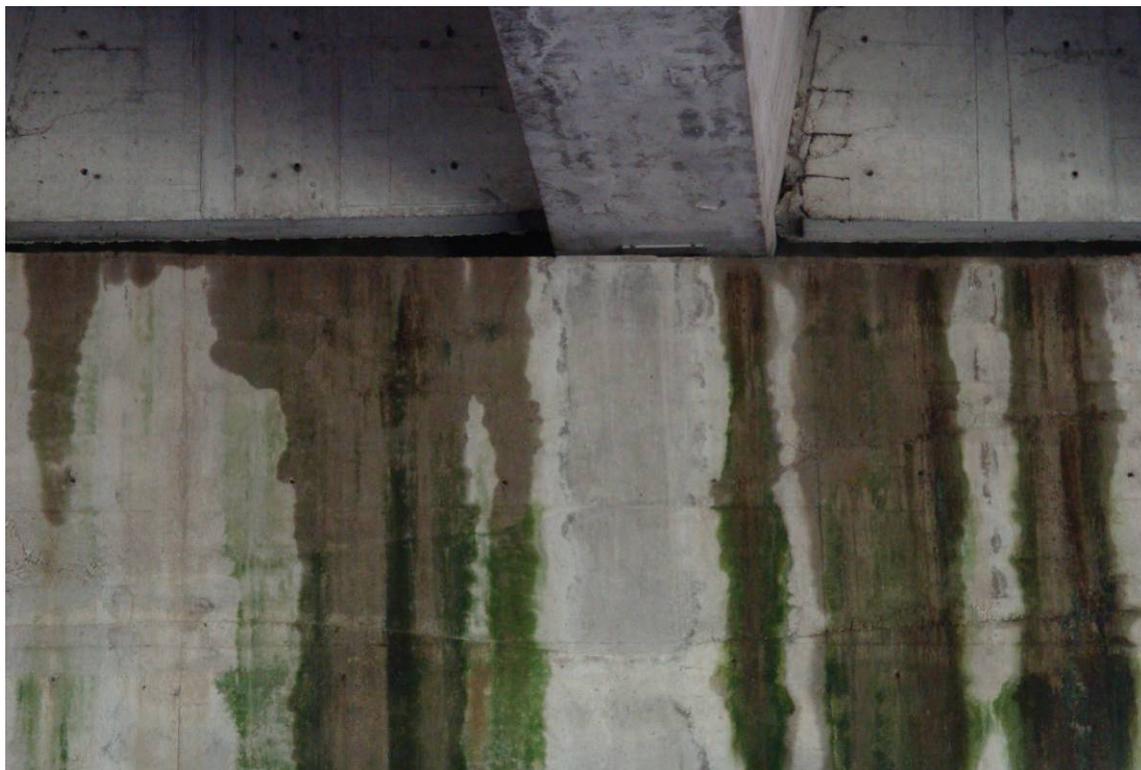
Particolare Setto della connessione a farfalla – scolature e dilavamento cls.
